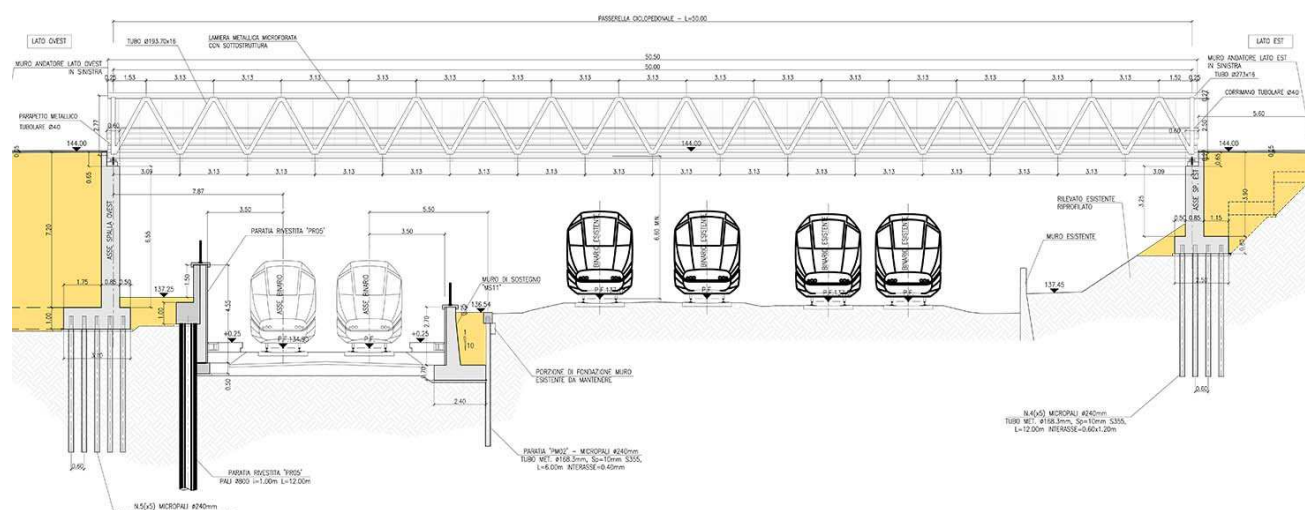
Sezione longitudinale passerella ciclopeditonale via Lopez.
